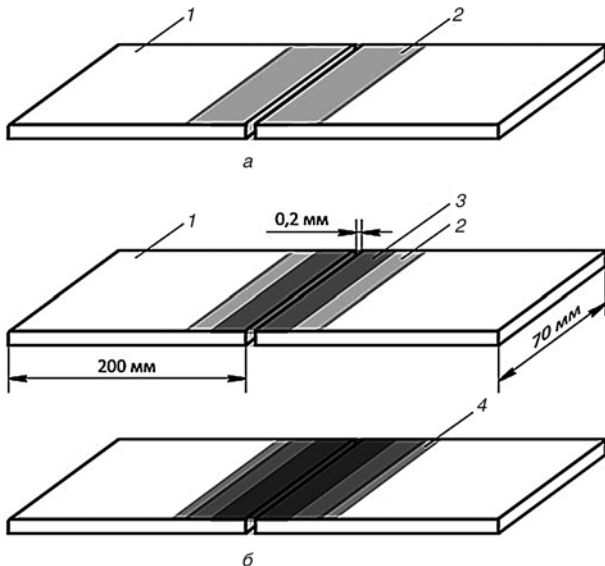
Образец для определения прочности стыка ГСП: *a* – образец без армирующей ленты; *b* – образец с армирующей лентой; 1 – образец ГСП; 2 – основной слой шпатлевки, заполняющий стык ГСП; 3 – армирующая лента поверх шва; 4 – верхний слой шпатлевки, нанесенный поверх армирующей ленты
